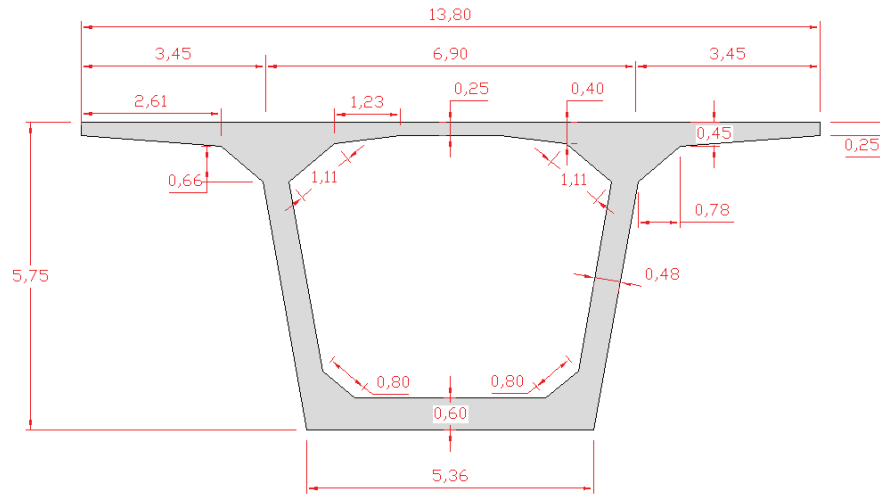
Coupe transversale du voussoir sur pile (VSP)
